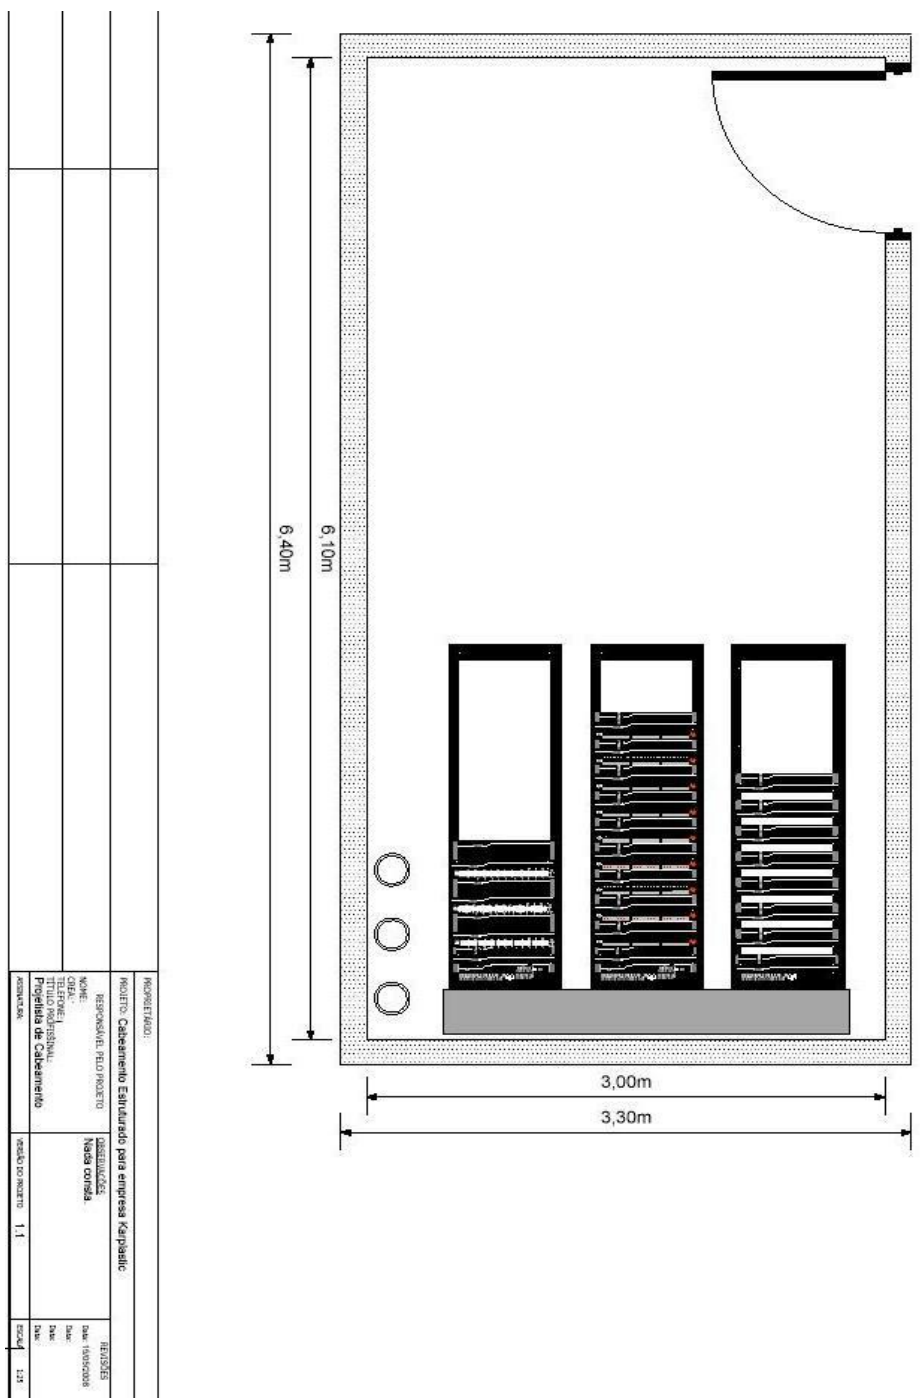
PLANTA DE TERMINAÇÕES E ROTAS
